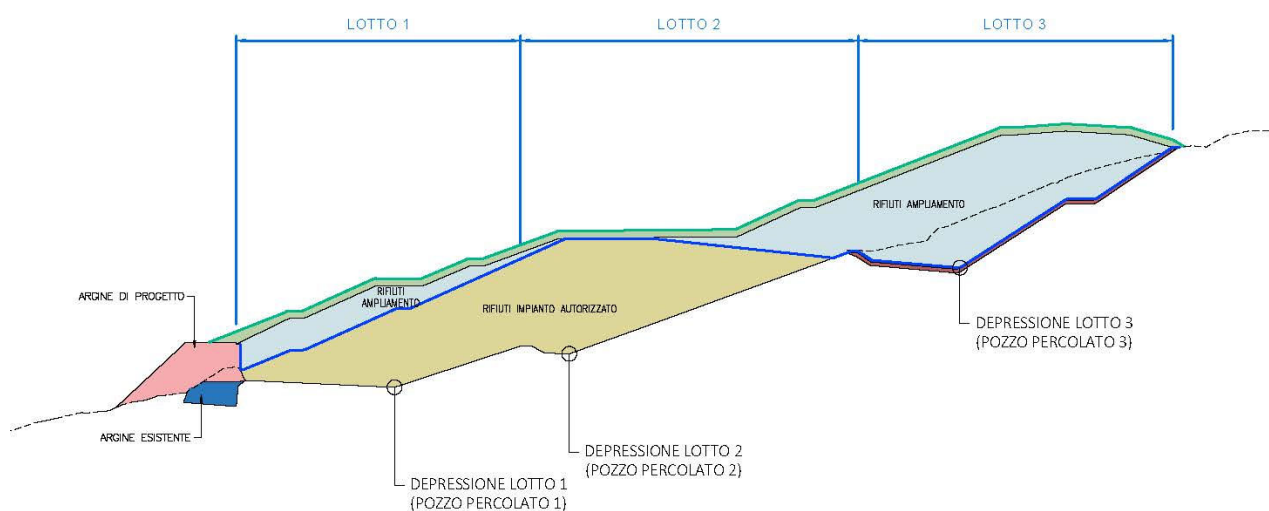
sezione schematica dell'impianto con evidenza delle zone più depresse in corrispondenza delle quali è prevista la costruzione in avanzamento dei pozzi per l'emungimento del percolato (due già esistenti e uno di progetto)
